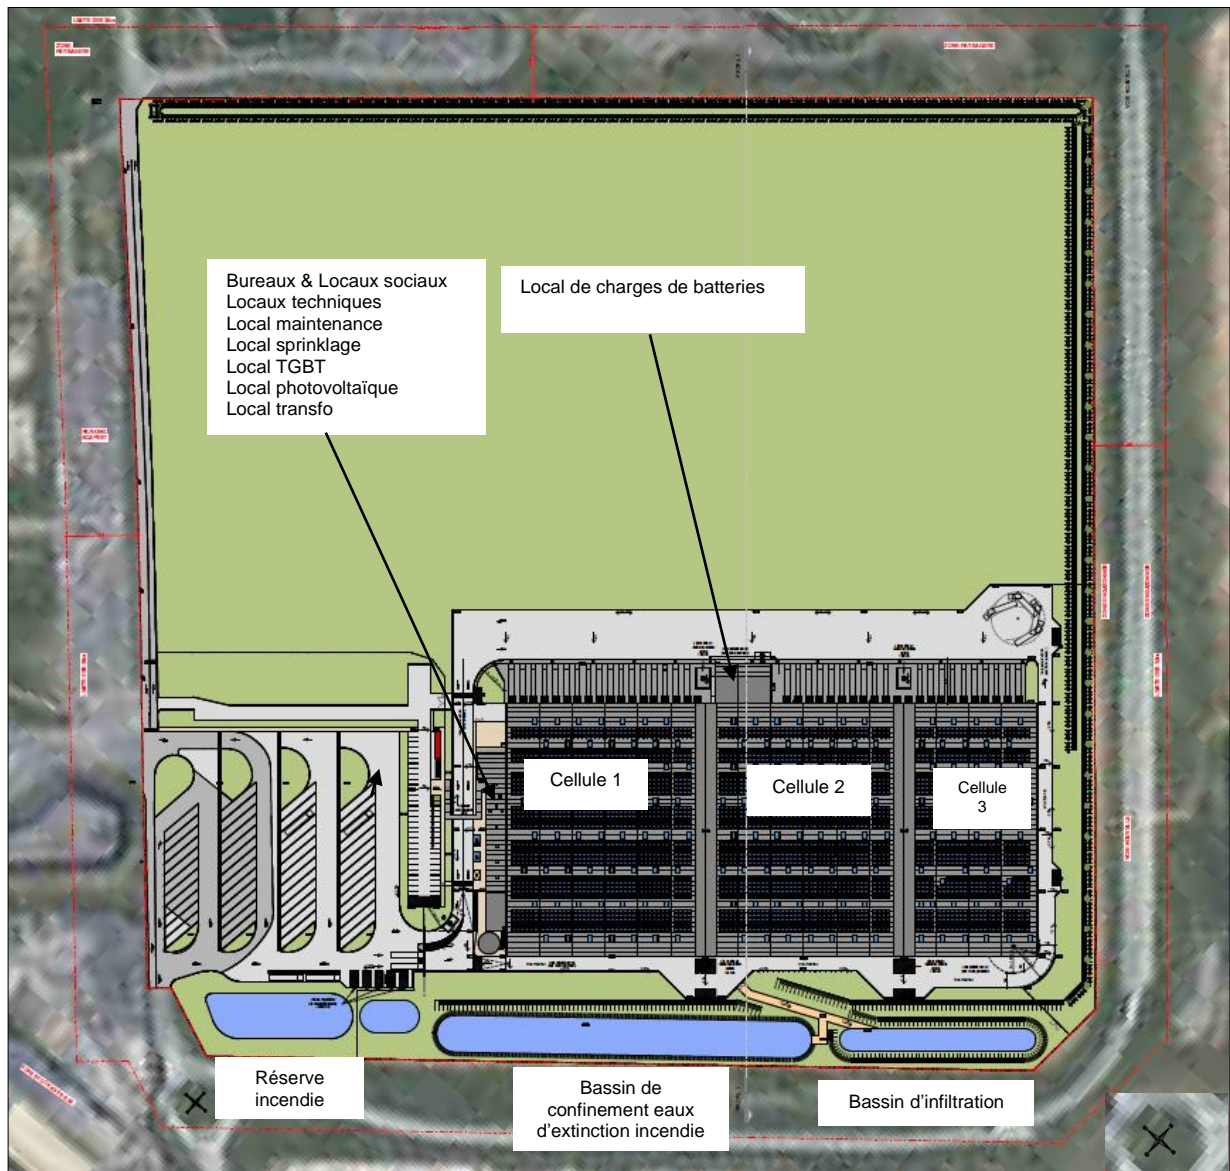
PLAN MASSE DES INSTALLATIONS
